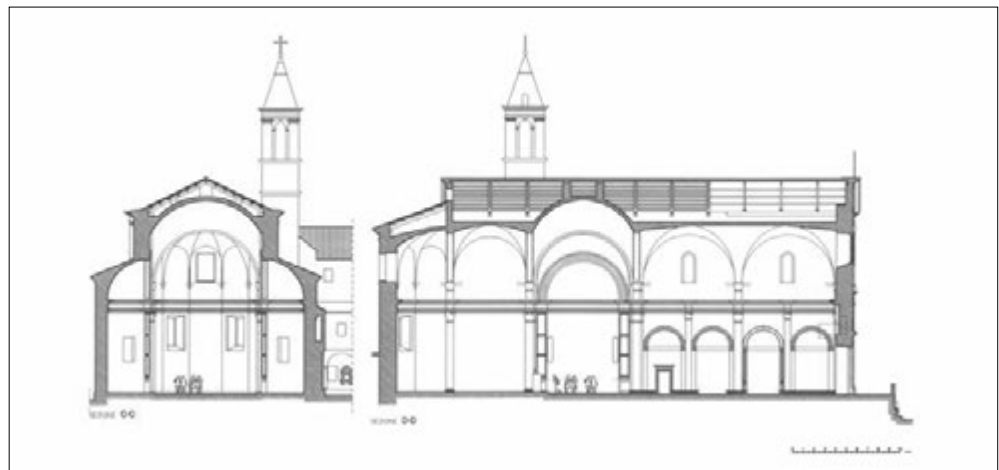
Chiesa di San Pietro in Montorio, sezioni C-C e D-D (rilievo di F. Cantatore, 1996)
